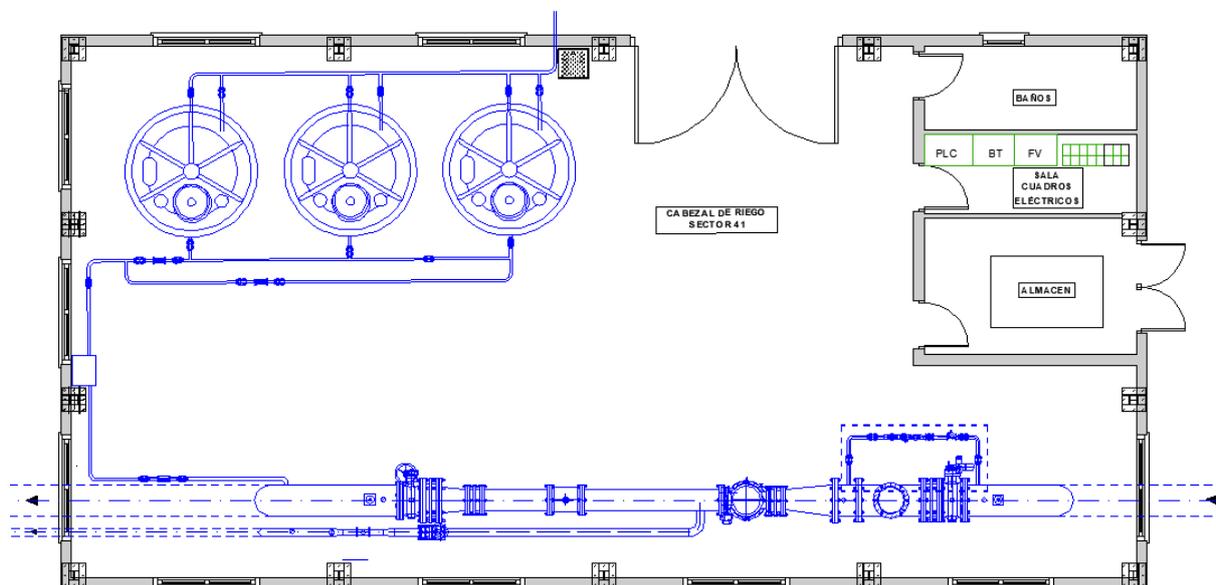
Vista planta instalación hidráulica y electromecánica cabezal sector 41
